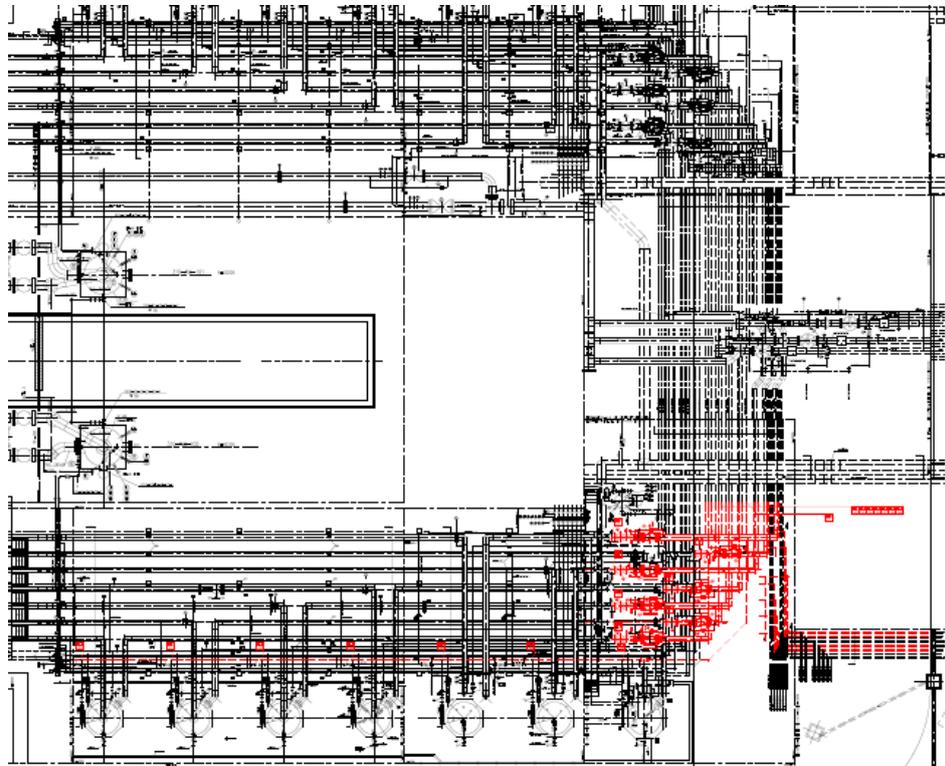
Planimetria Tie-ins di Centrale – Fase 1 (in rosso smantellamenti Fase 1)
